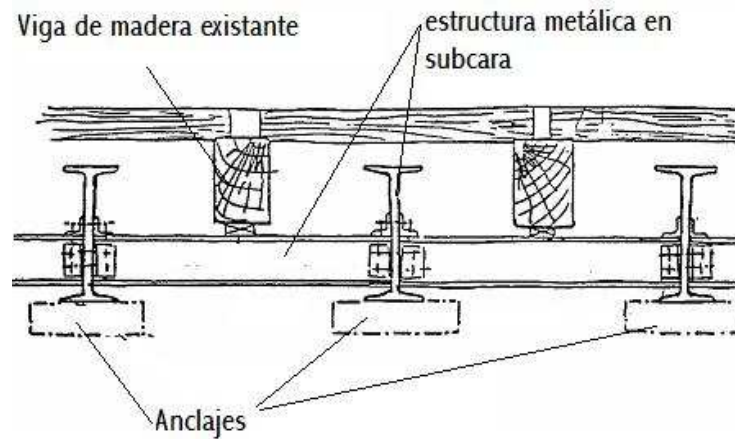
Colocación de una estructura metálica debajo del forjado
